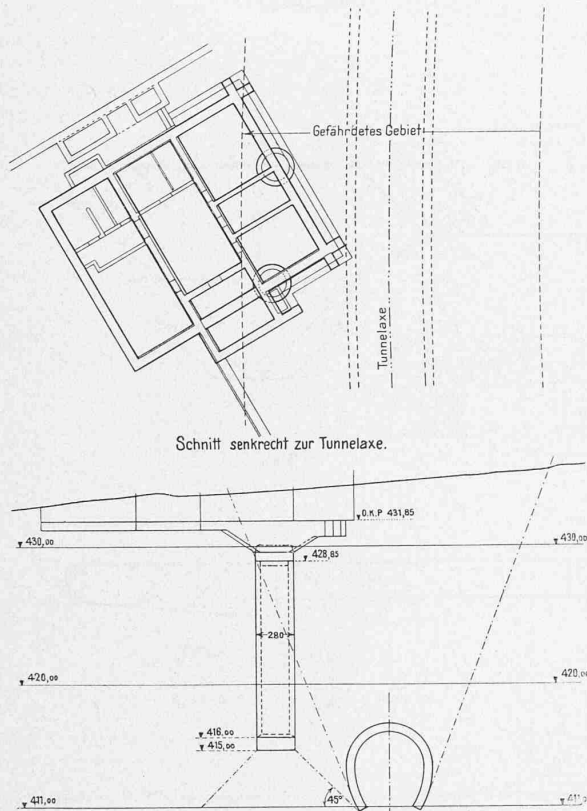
Lageplan und Vertikalschnitt. — Masstab 1:500.
